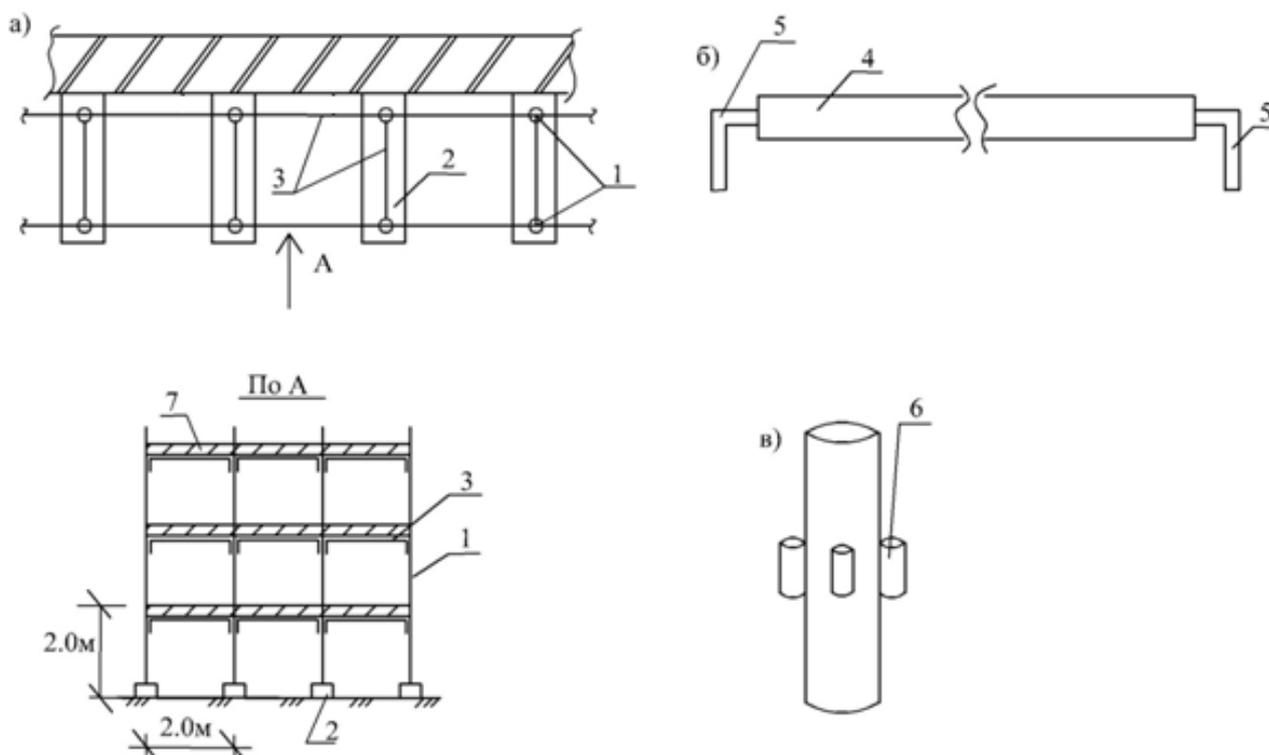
Схема установки трубчатых безболтовых лесов:
